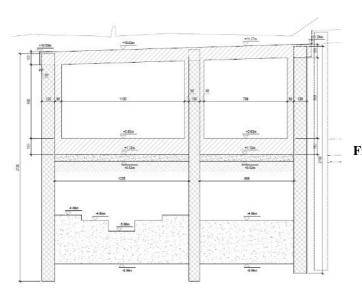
Sezione GA Fornaci II – Sezione tipo a due canne
